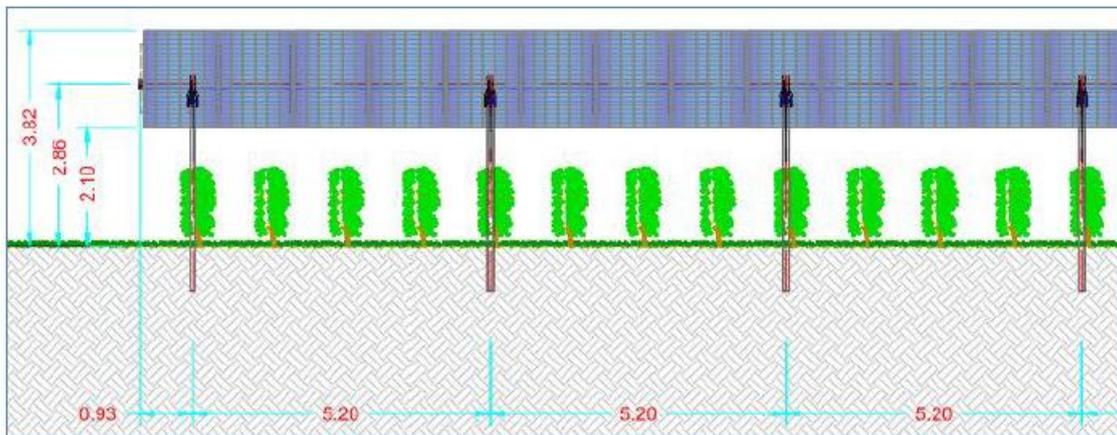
Sezione longitudinale tipologica struttura Tracker con vigneto
